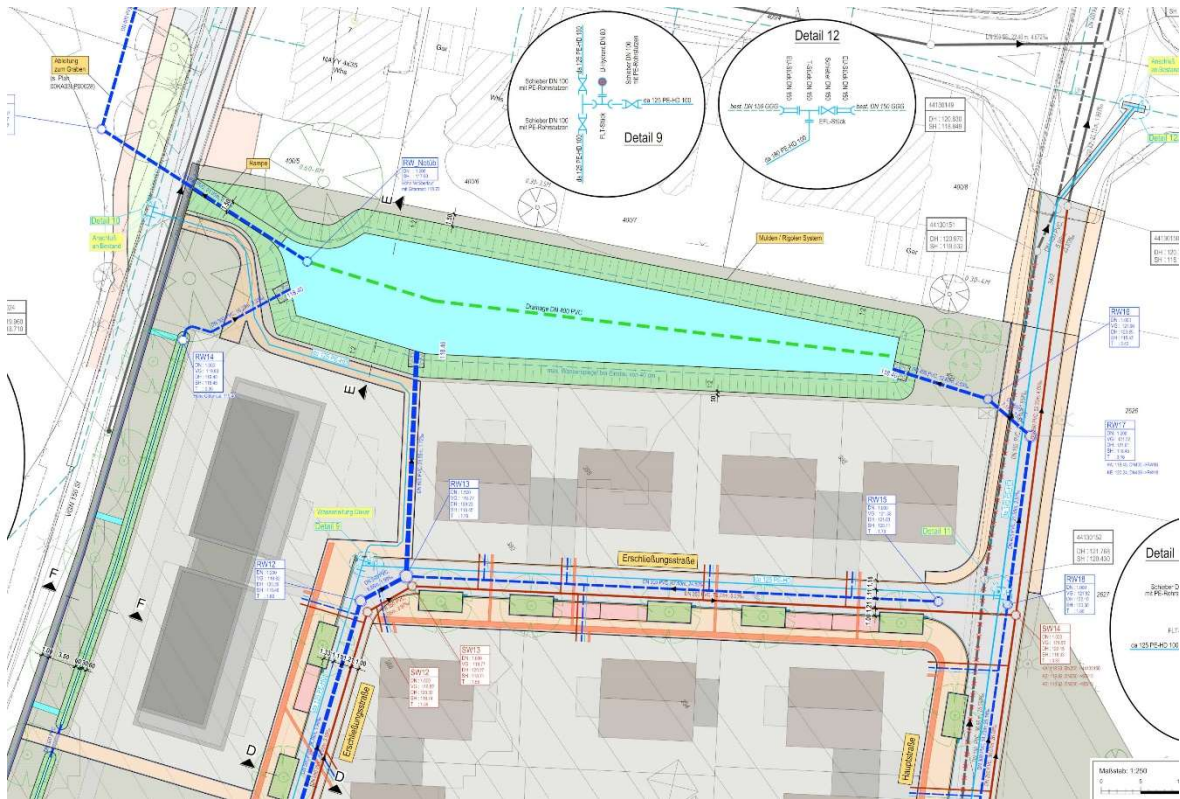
Ausschnitt aus dem Entwässerungskonzept mit Retentionsbecken (Quelle: BIT Ingenieure, Karlsruhe)
